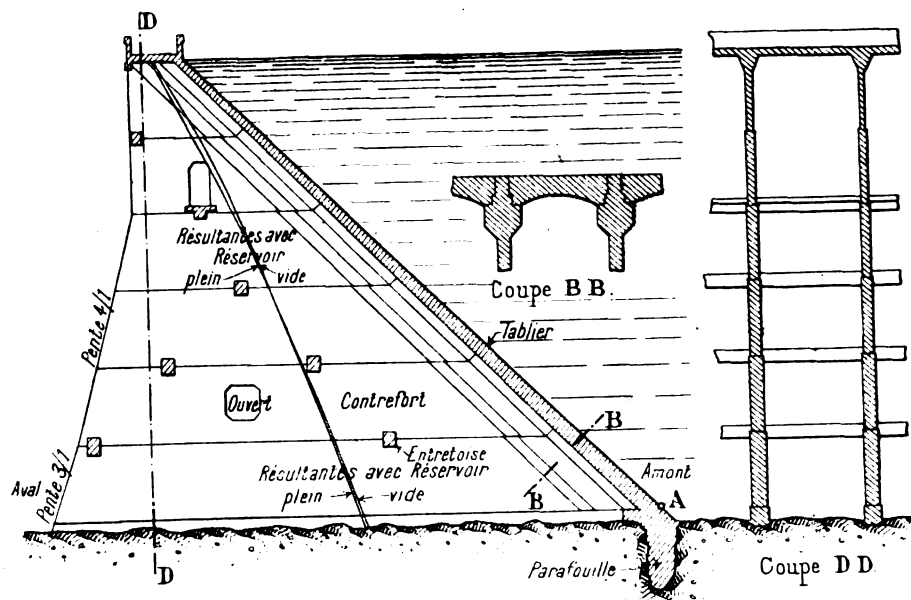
Profil et détails d'un barrage évidé en béton armé.
